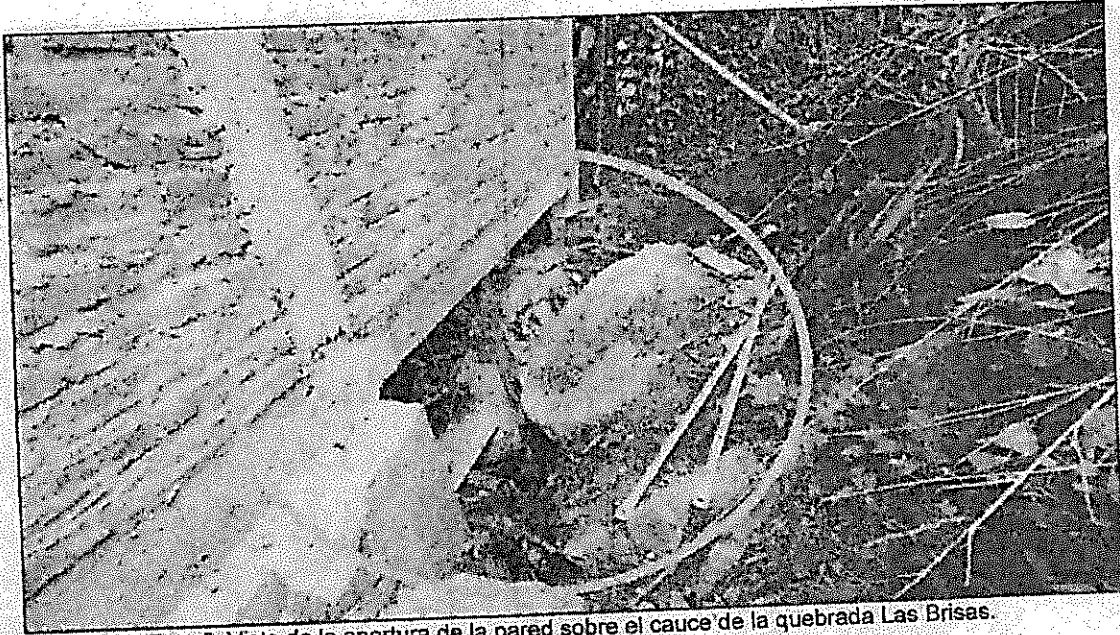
Vista de la apertura de la pared sobre el cauce de la quebrada Las Brisas.
